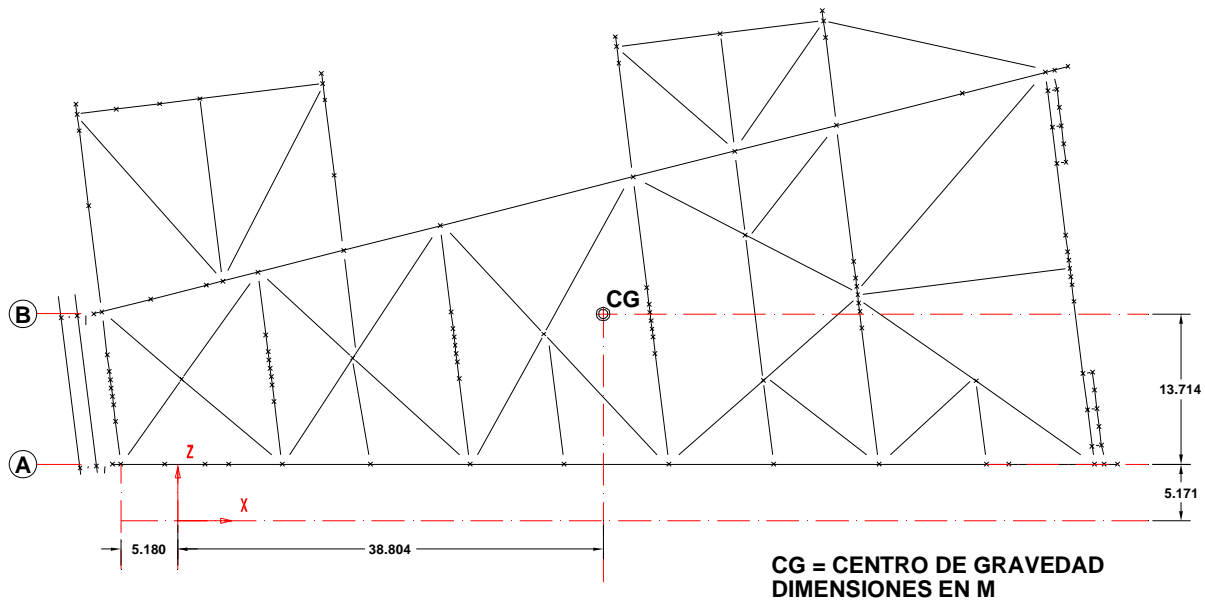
Centro de gravedad en elevación para la maniobra de lanzamiento
